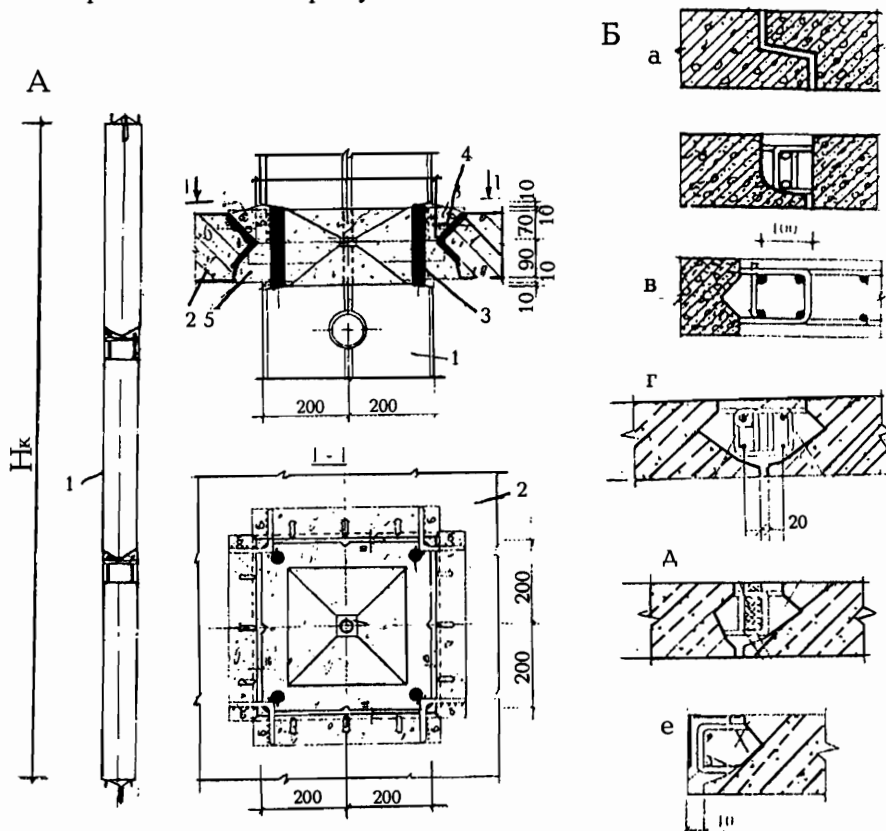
А – конструктивное решение многоярусных колонн и схема устройства стыков с надколонными панелями. Б – соединения надколонных плит с рядовыми: 1 – колонна; 2 – надколонная плита; 3 – рабочая арматура колонны; 4 – закладная деталь; 5 – монолитный участок; а – опирание плит "в четверть"; б – со стыковкой петлевых выпусков сборных плит; в – стыковка сборных плит и монолитных участков; г –стыковка сборных плит; д – стыковка сборных плит с пенополистирольным вкладышем; е – монолитные торцевые участки плит
